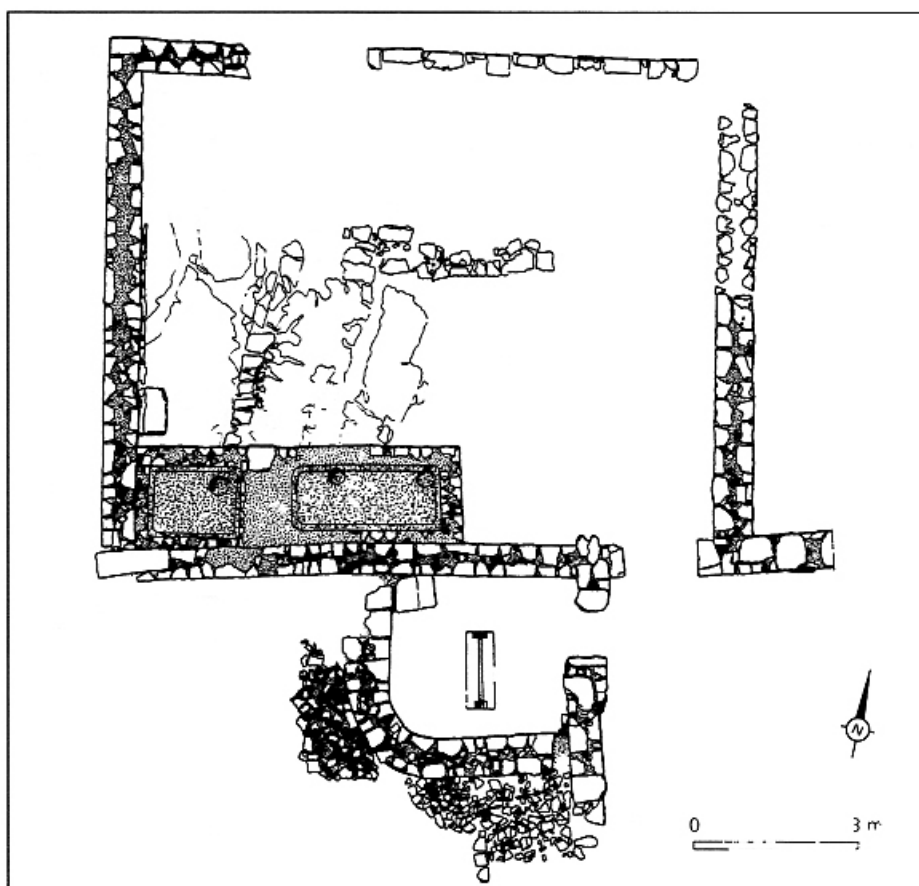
Planta do lagar (Desenho de Severno Rodrigues)
